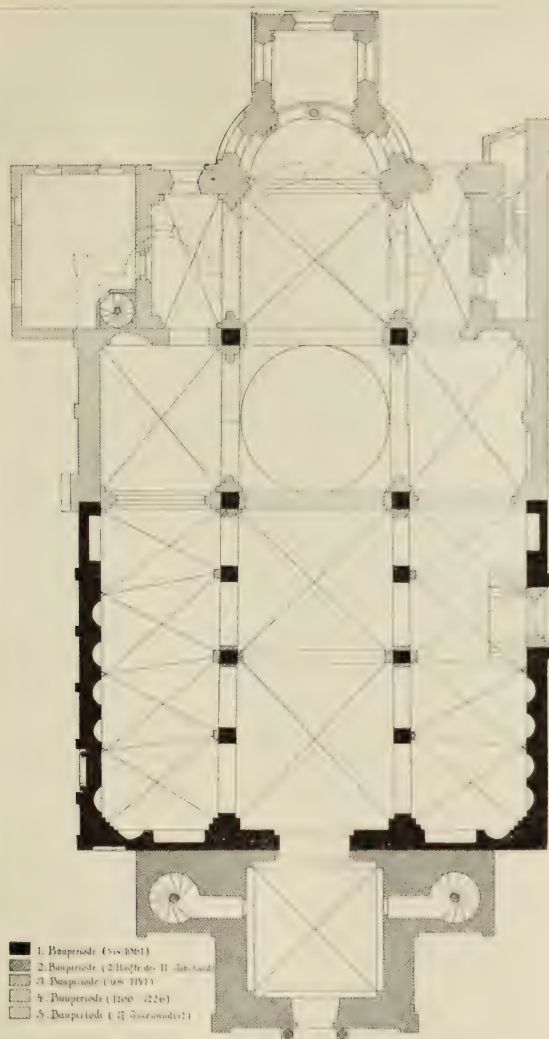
Brauweiler Grundriss der Abteikirche
